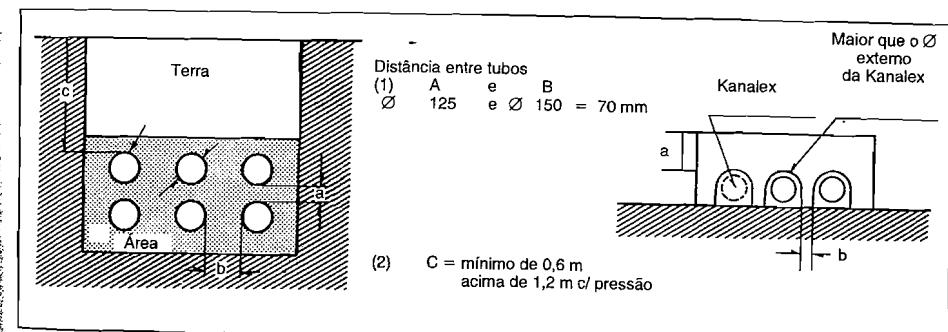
Instalação do duto flexível Kanalex. Fabricante Kanaflex
